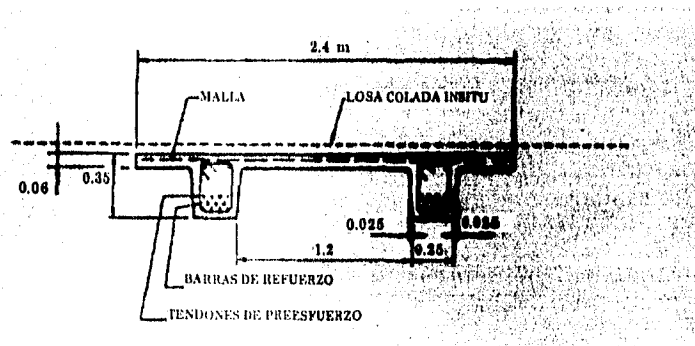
Sección transversal de las vigas precoladas TT (tomado de la Ref. (15))
